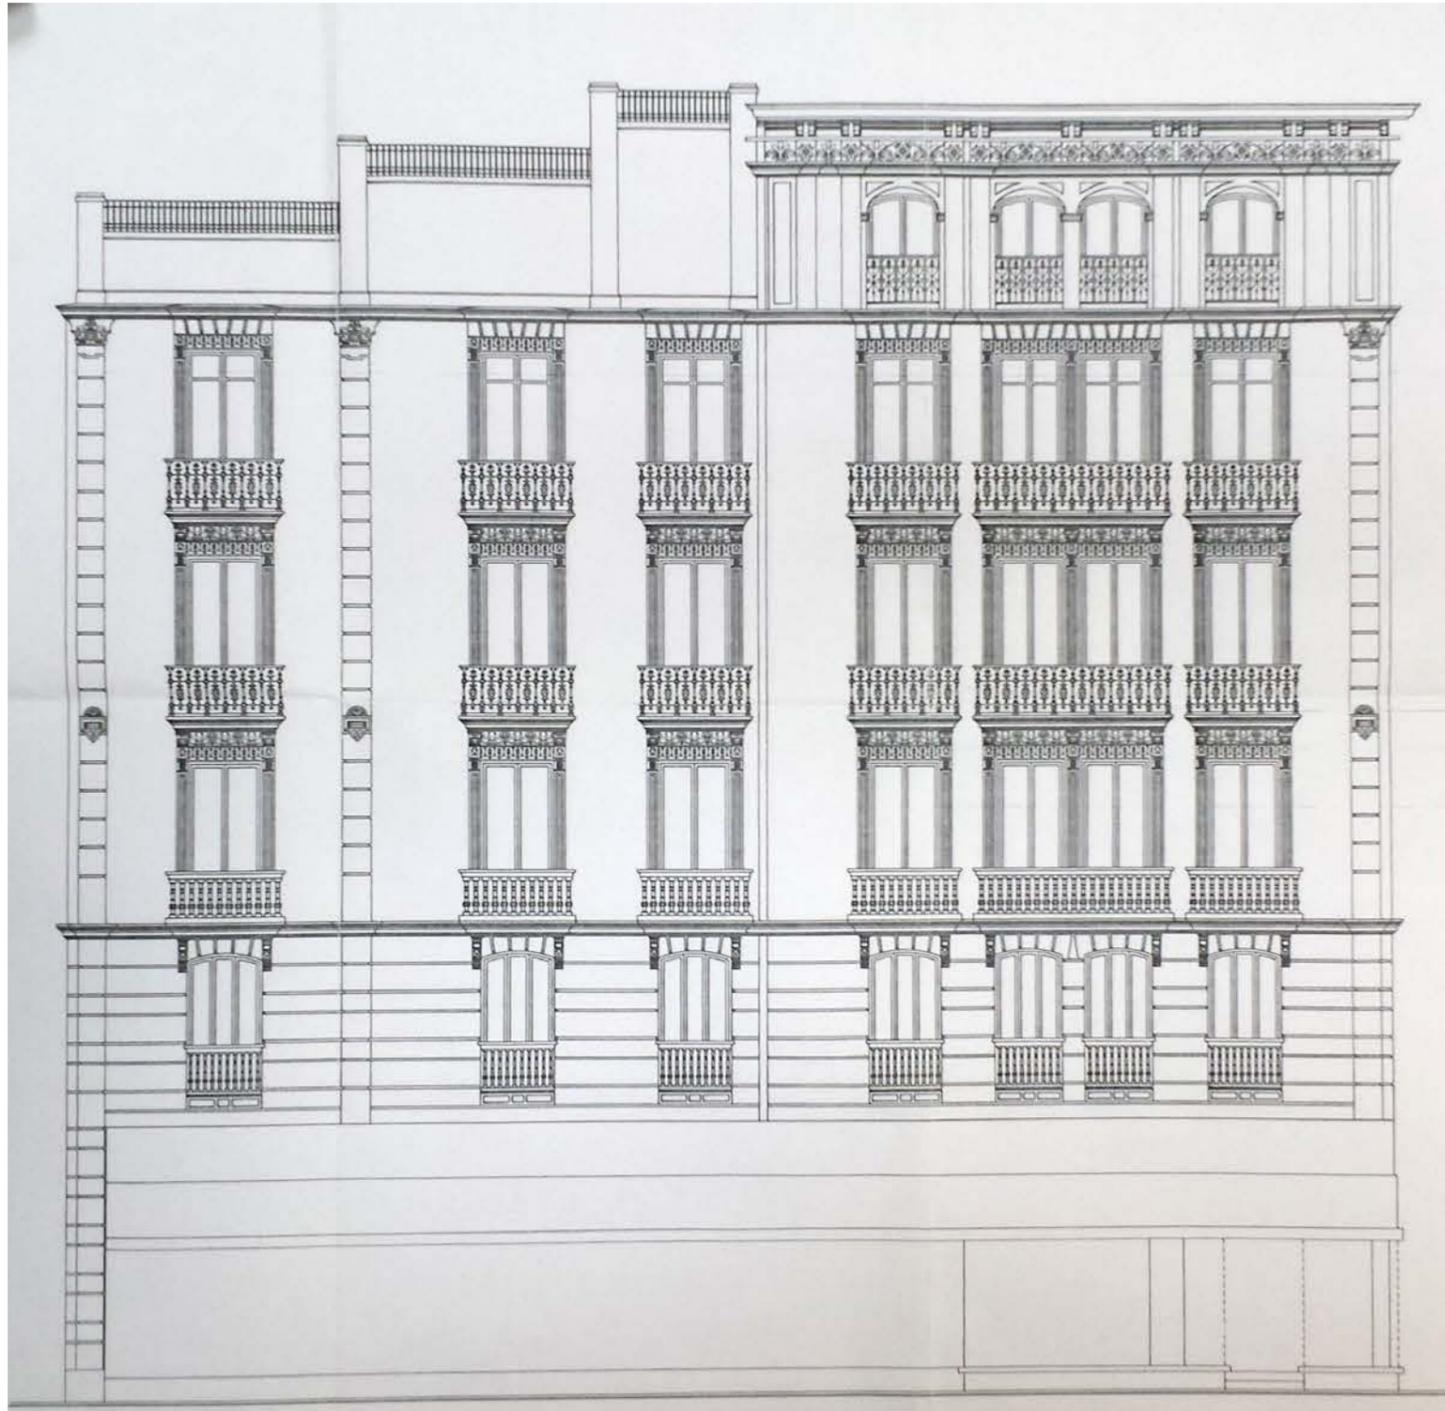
Estado Actual Alzado Calle San Juan de Ribera 1997.
